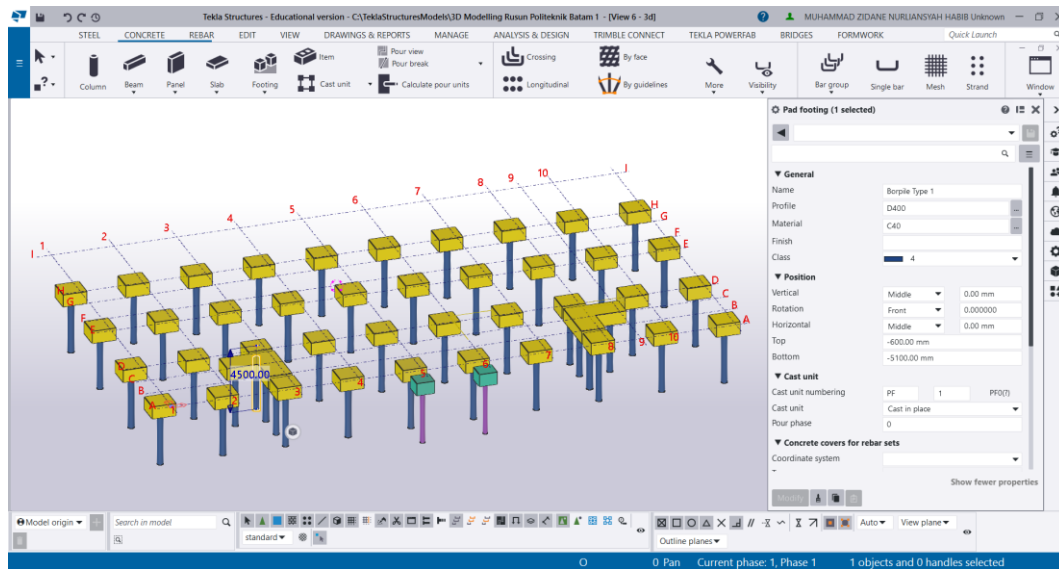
3D Pembetonan Borpile dan Pilecap
